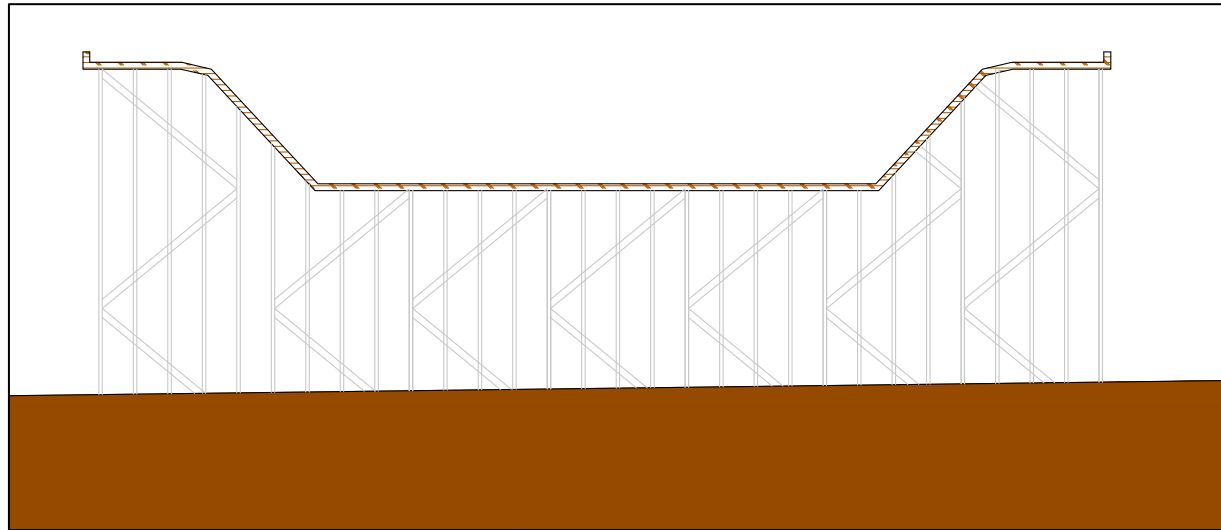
Cimbra y encofrado de losa inferior y voladizos. .
